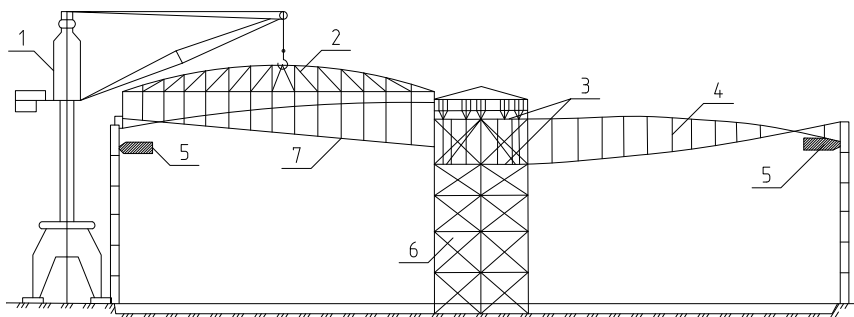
Технологическая схема монтажа покрытия вантовыми фермами:
